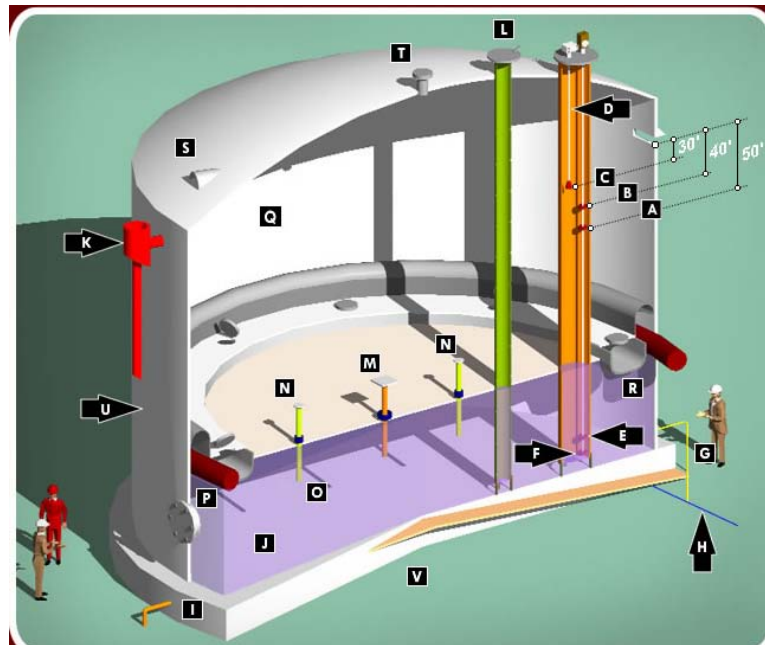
Tanque vertical con M.I.F. de acero y techo fijo.
